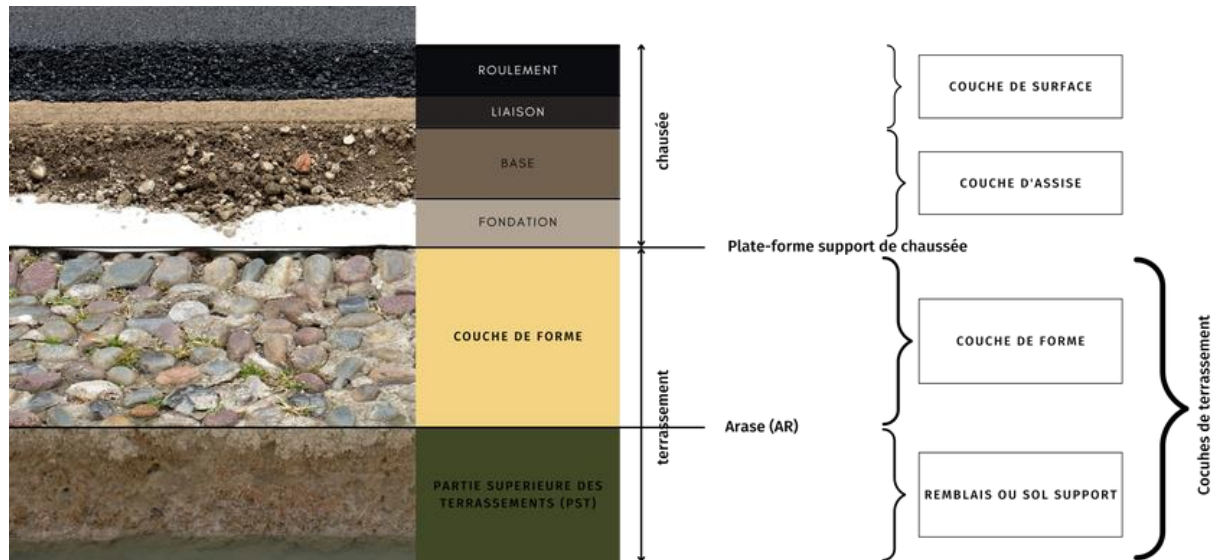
Les différentes couches de la chaussée routière (Ordener, 2023).
